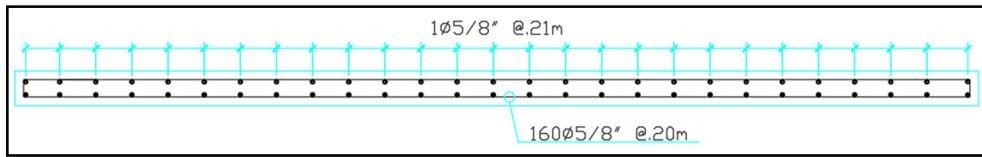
Distribución acero refuerzo de la losa o tablero 0.2 m x 5.60 m.
